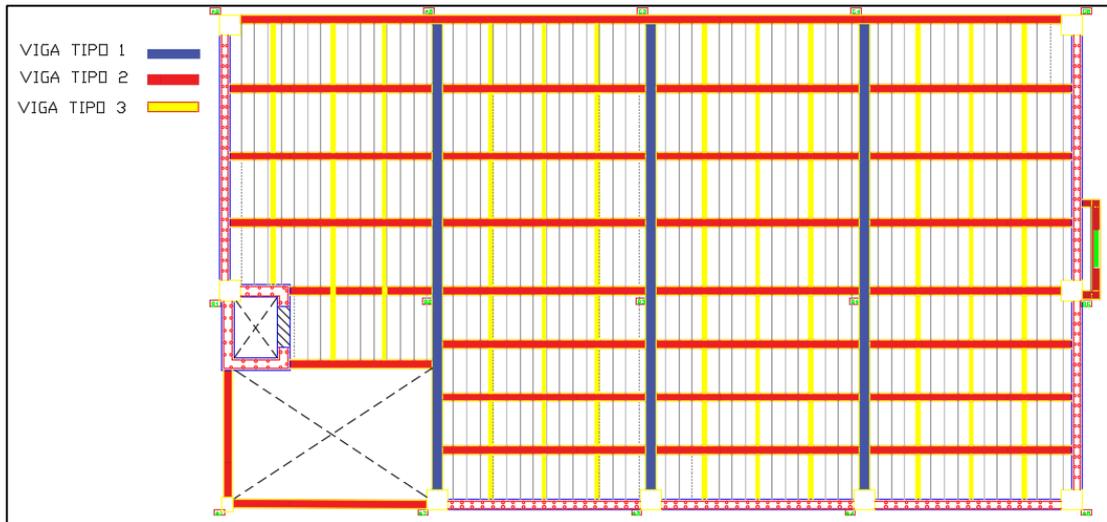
Esquema de distribución de tipos de vigas N+1,62 (Acero)
